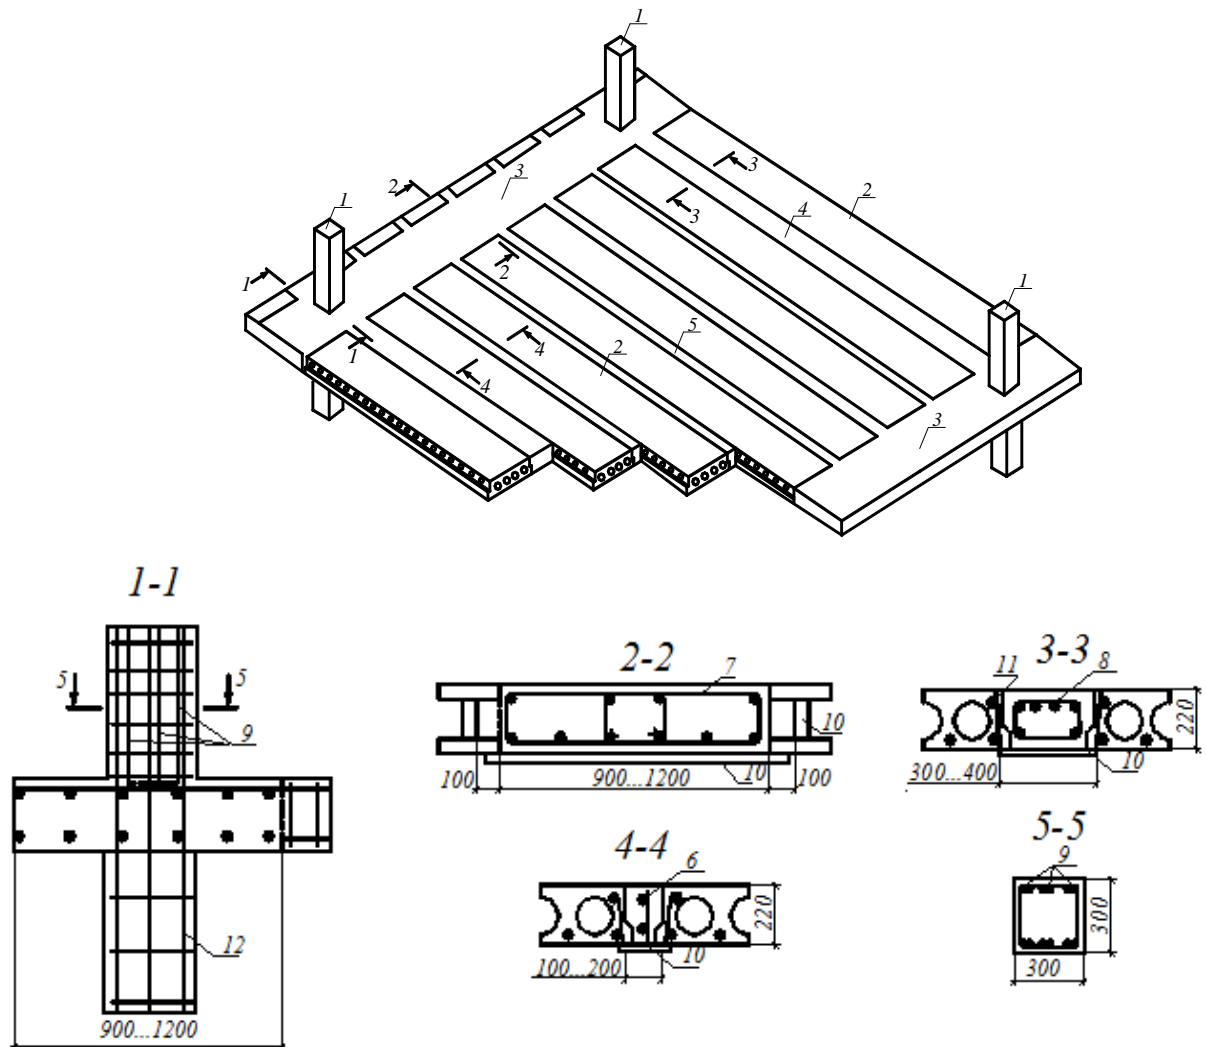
Збірно-монолітне перекриття типу «СОЧІ»: 1 – колони; 2 – збірні плити перекриття; 3 – монолітні ригелі; 4, 5 – монолітні балки між колонами та збірними плитами; 6 – 8 – арматурні каркаси монолітних елементів перекриття; 9 – стикові стрижні; 10 – опалубка; 11 – шпонка; 12 – арматурний каркас колон
